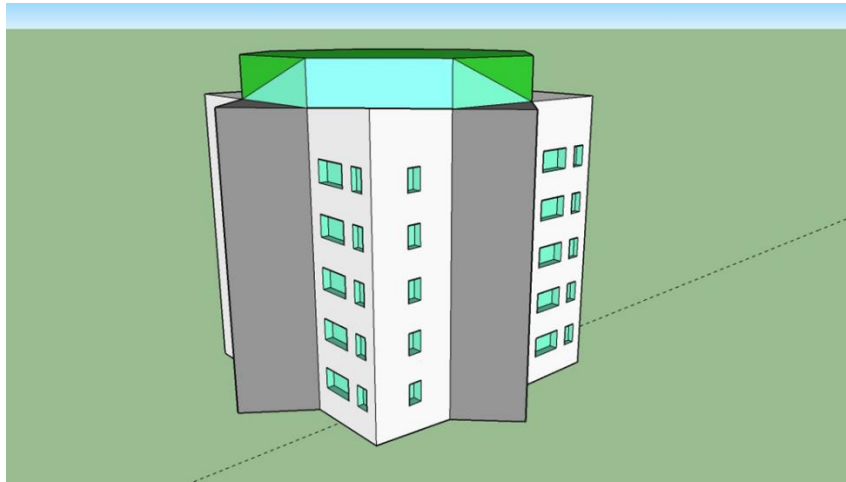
Modellazione dell'edificio tramite SketchUp©.
